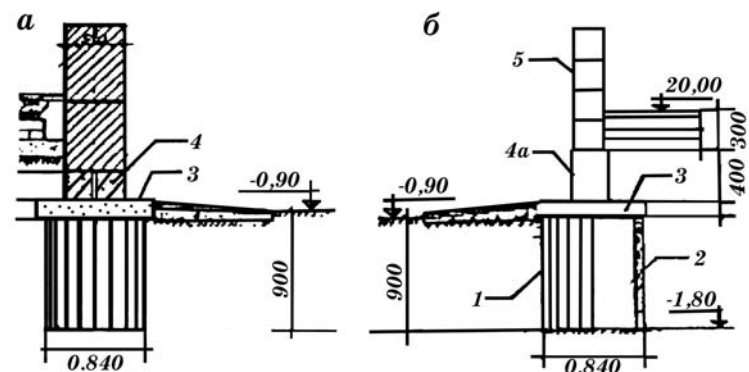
Пример укладки перемычек. а — со стенами из кирпича, блочных камней; б — со стенами из деревянного бруса: 1 — железобетонное кольцо КС7.9; 2 — песчано-гравийная смесь; 3 — железобетонная плита 90х90 см; 4 и 4а — несущие перемычки или фундаментная балка; 5 — стены из бруса.
